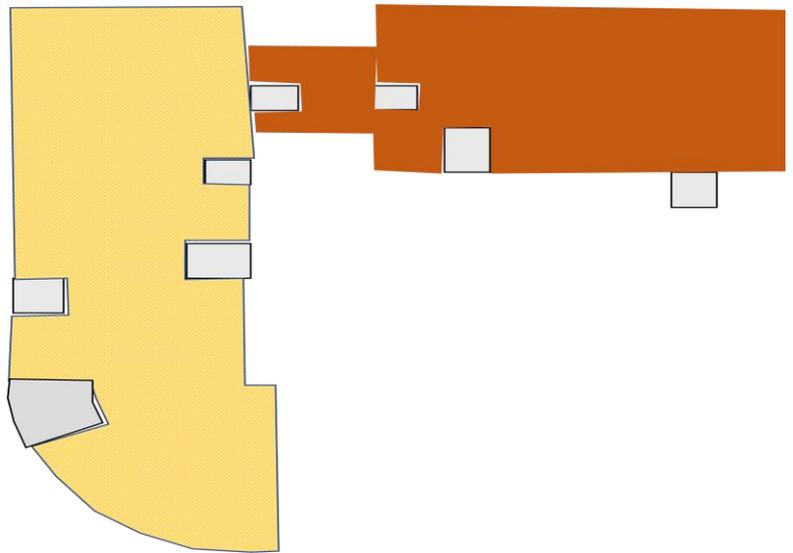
les dalles utilisé dans notre projet. source: auteurs.
